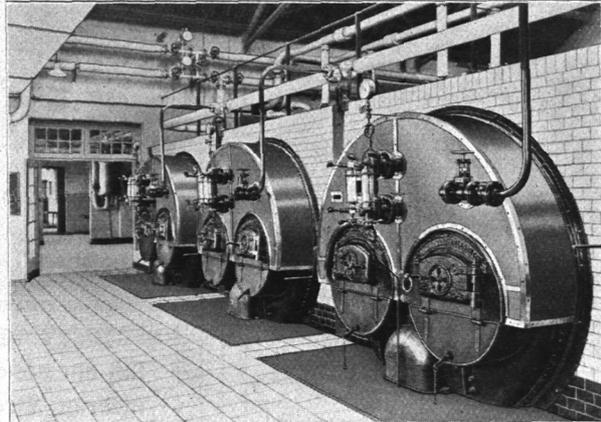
Badeanstalt Hammerbrook, Dampfkeffelanlage.
